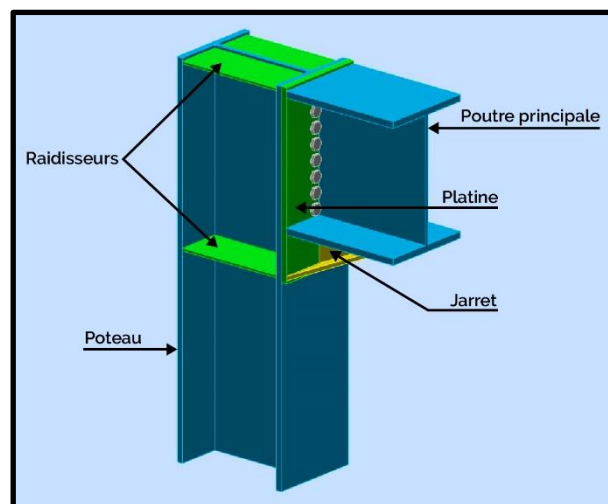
Assemblage poteau HEA 400 – poutre HEA 450
